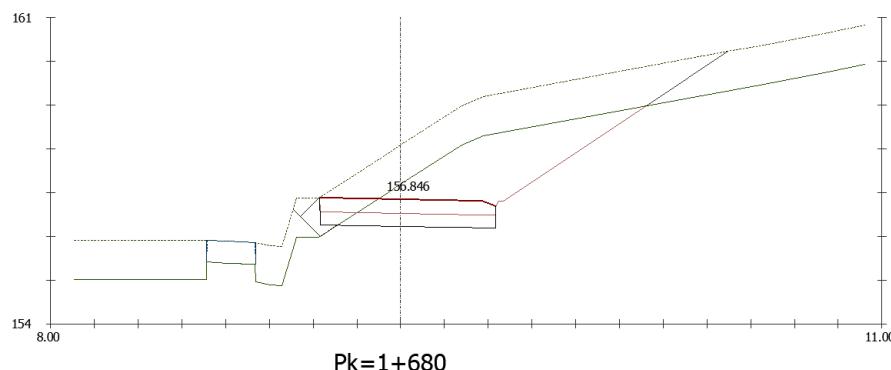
Perfil transversal PK 1+680. Fuente: Plano 6 del proyecto
